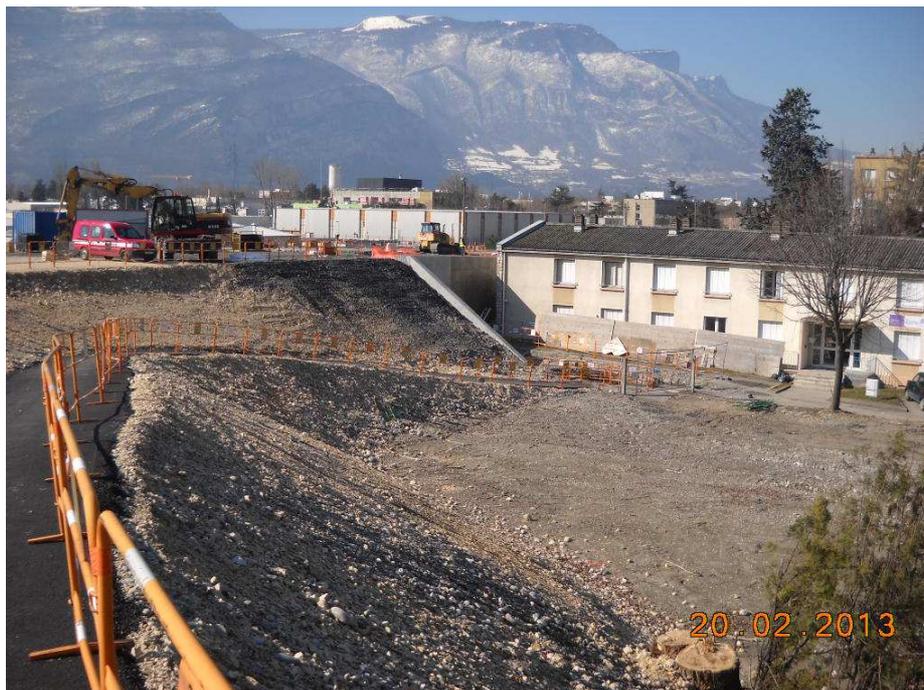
Suivi des tassements d'une plateforme de tramway fondée sur remblai
